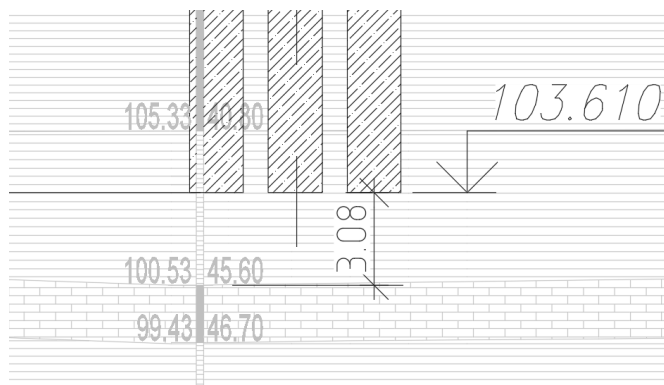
Расстояние от низа свай до кровли карстующихся грунтов [85]
